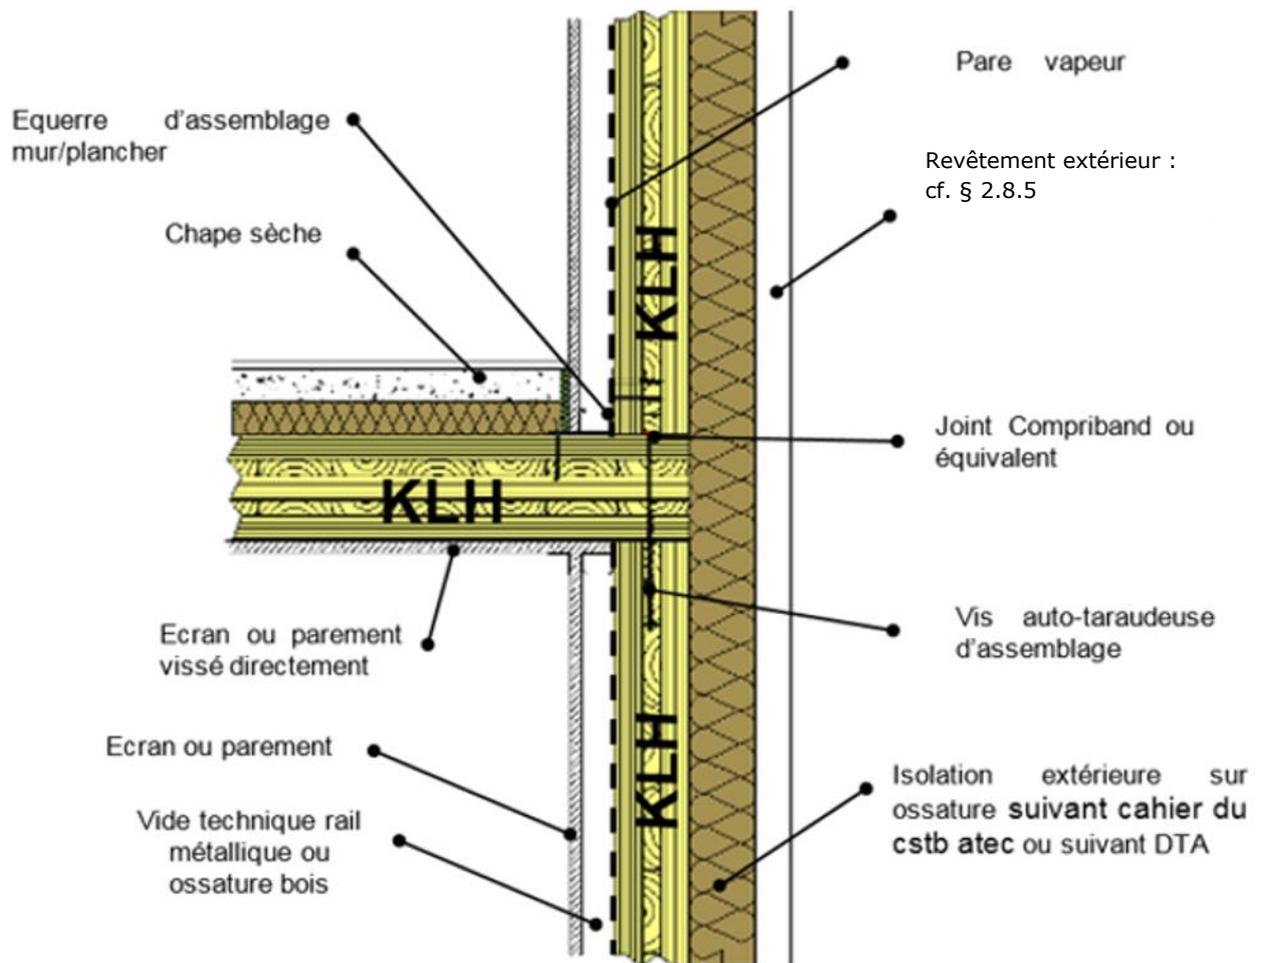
Assemblage mur/plancher locaux superposés dans un même logement
